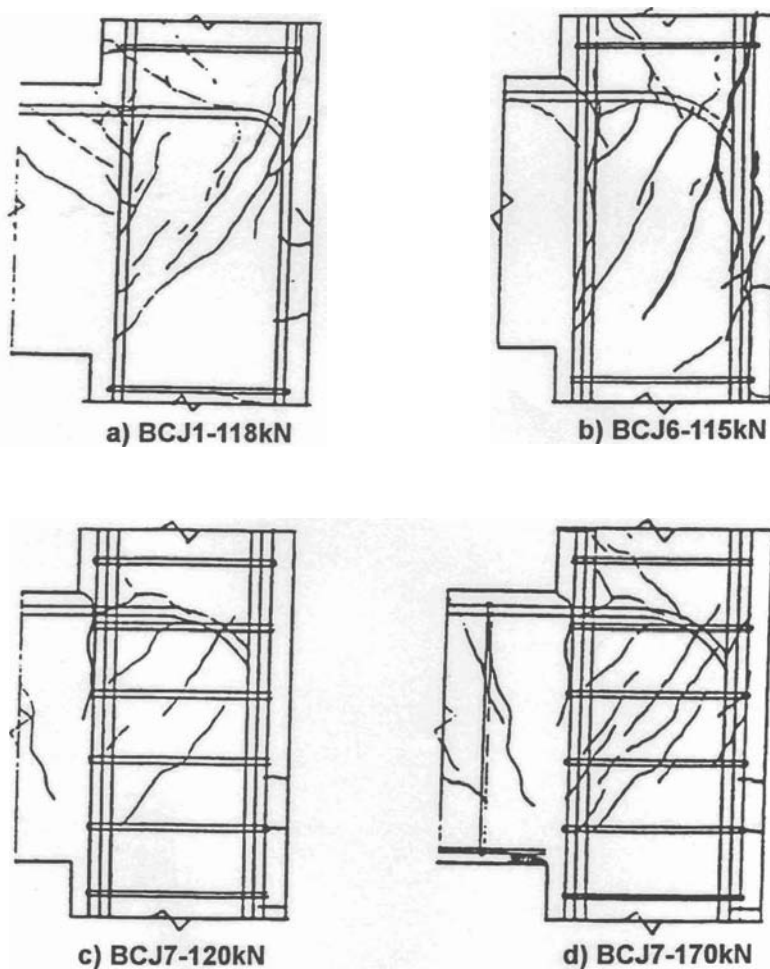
Arranjos de armaduras e panorama de fissuração dos pórticos [ORTIZ,1997]
